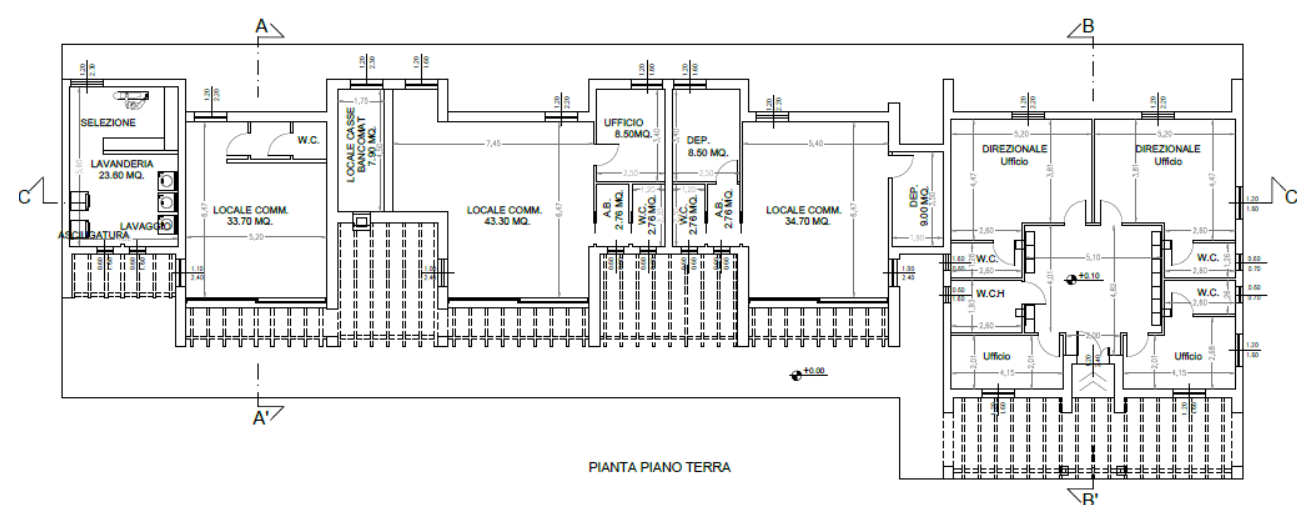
Planimetria edifici servizi portuali e spazi commerciali
